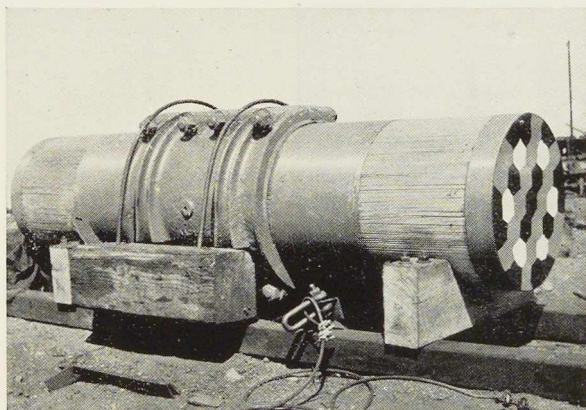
Aspect d'un tronçon d'essai du câble, après compression par la machine de serrage.
